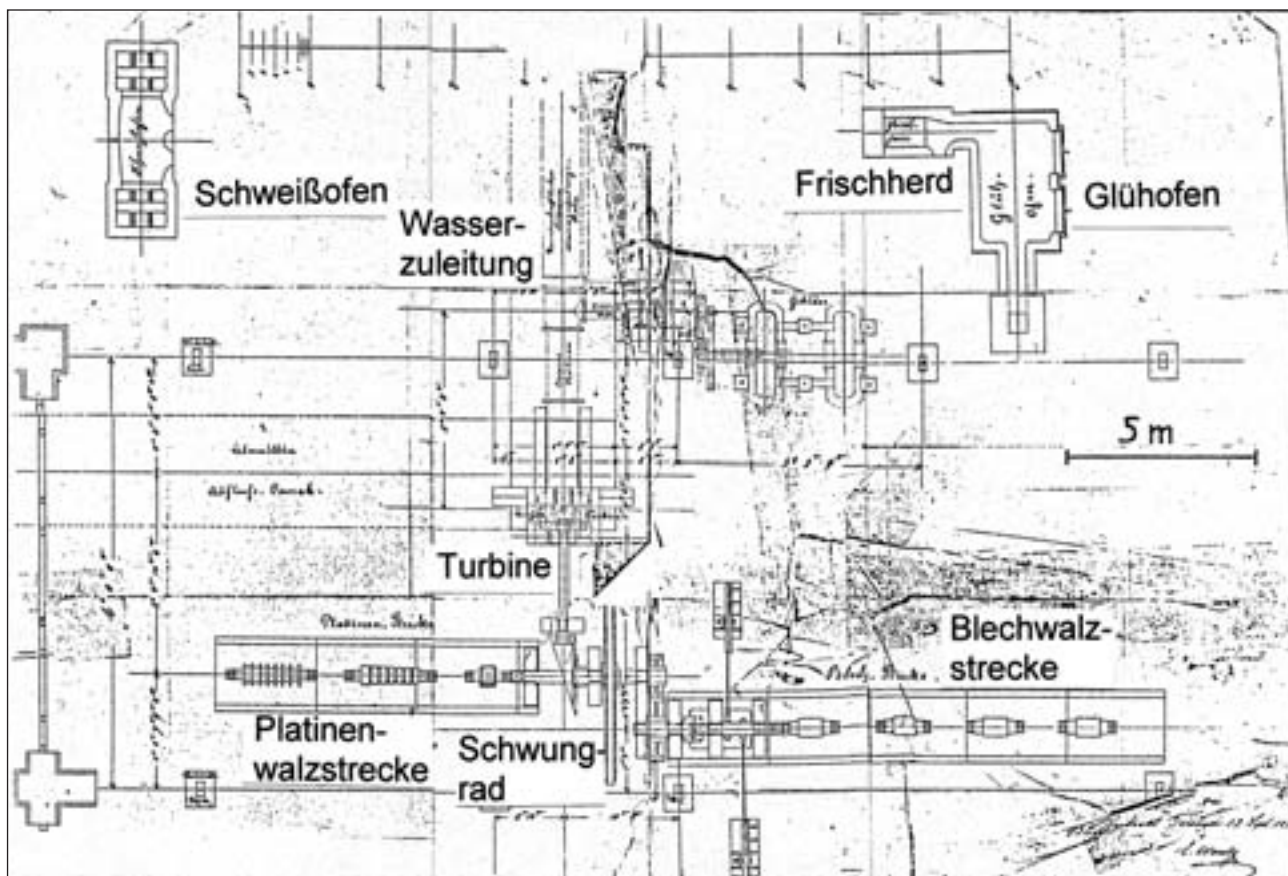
Trieben. Stahl- und Blechwalzwerk „Benedictshütte“ einer vom Stift Admont angeführten Kommanditgesellschaft; Grundriss der Werksanlage. Ausschnitt aus dem mit 12. September 1871 datierten Plan „Blechwerk Trieben im StAA/Plansammlung (für die Wiedergabe geringfügig verändert)
